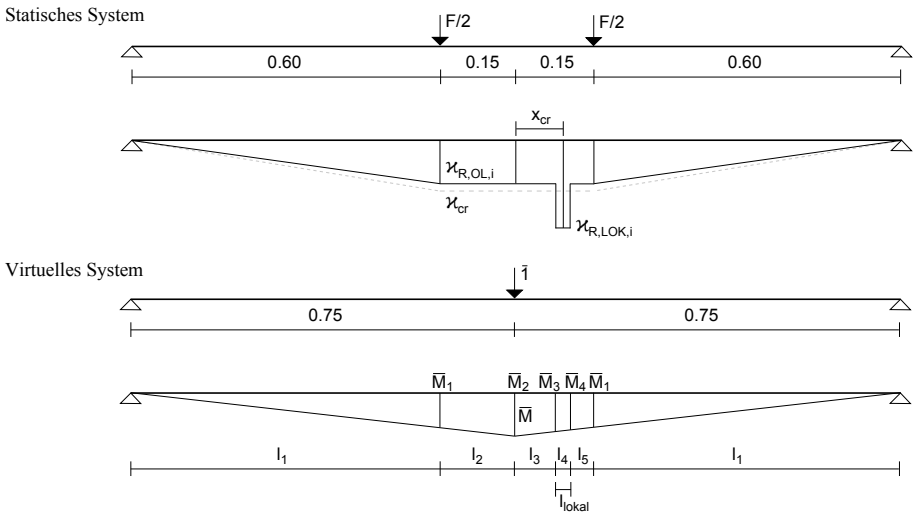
Bestimmung der Krümmung im Makroriss für Fall A (große Balken aus Normalbeton)
